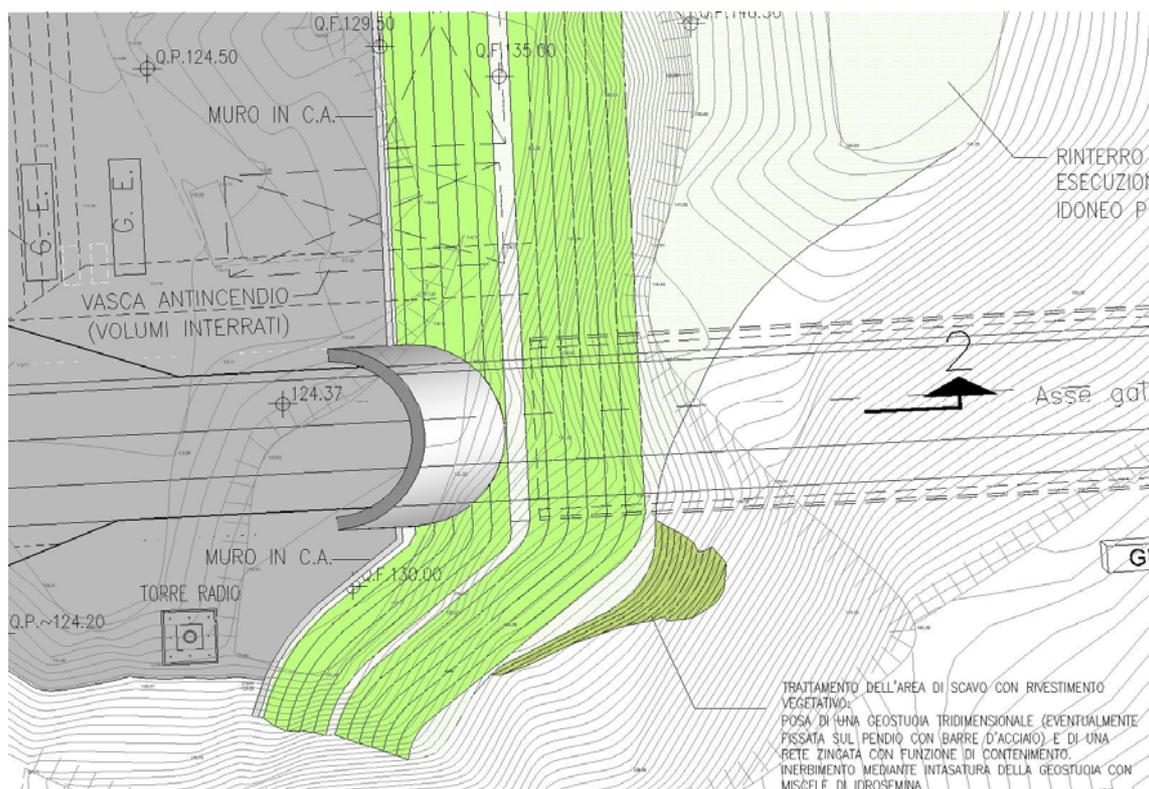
Dettaglio planimetrico imbocco carreggiata est (cfr. AUA0146-1)
